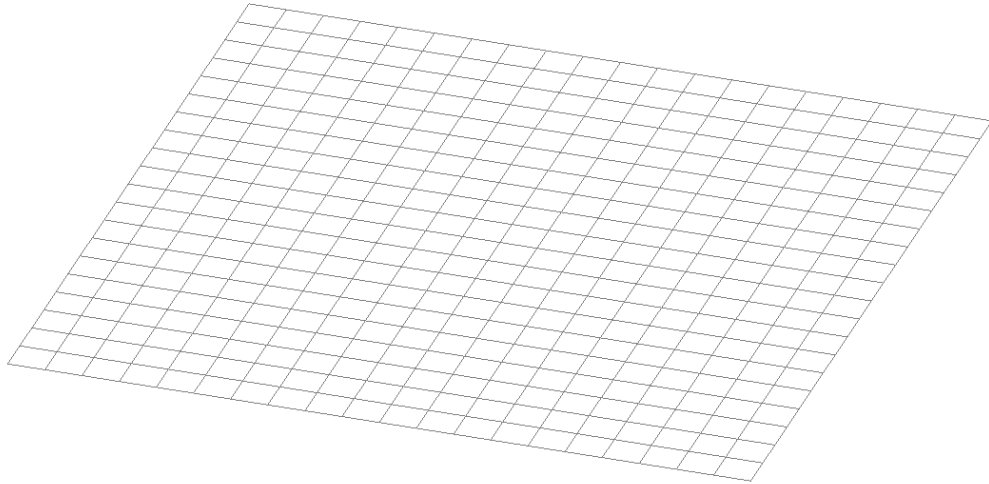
Фундаментна плита з розмірами 13,94x13,95 м
